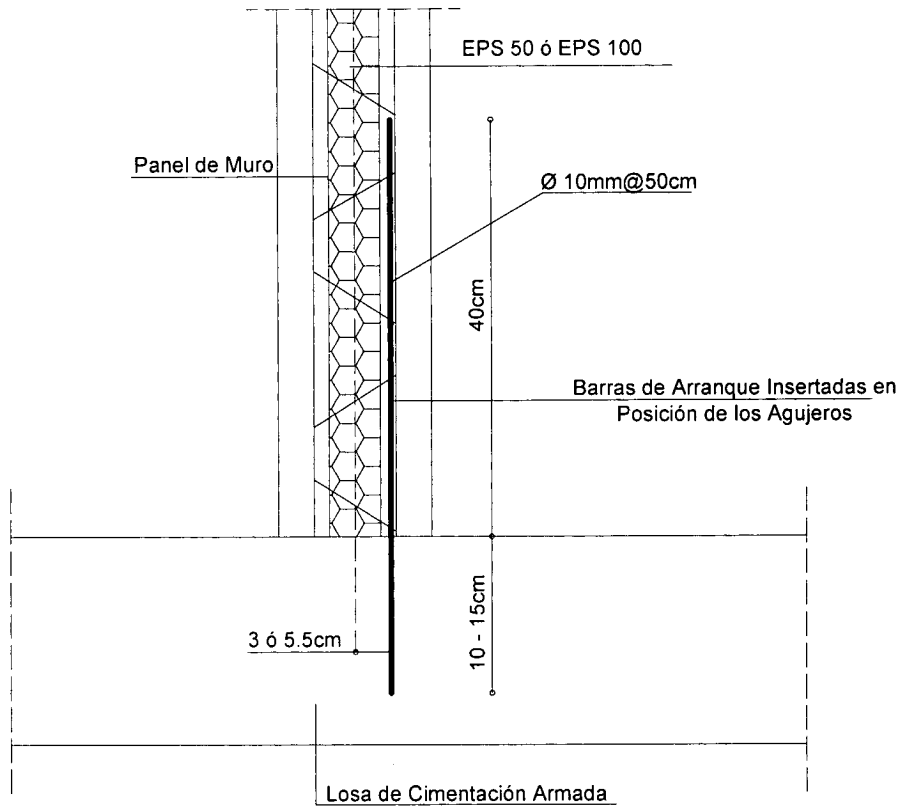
Conexión entre la losa de cimentación y el muro interior mediante las barras de arranque.
